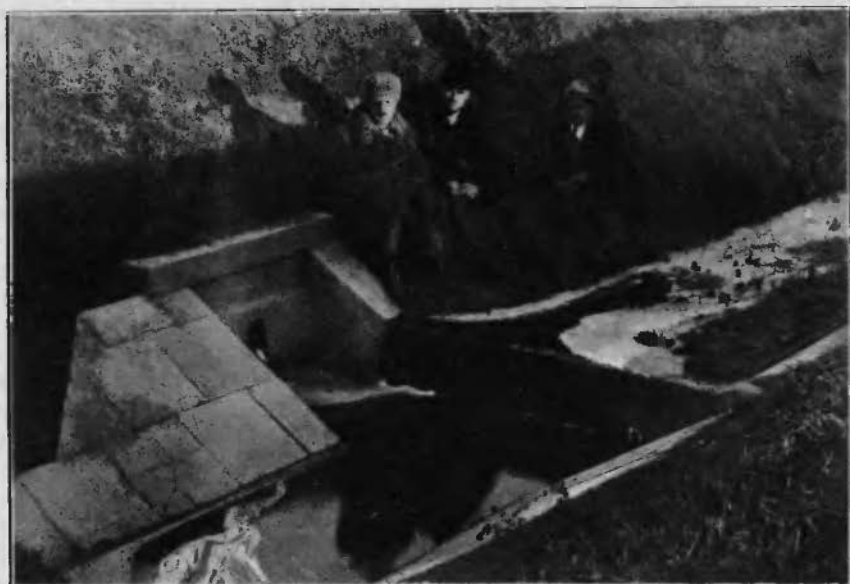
Typ wylotu krytego betonowego według projektu inż. Aleksandra Wierzbickiego (1 : 50).
